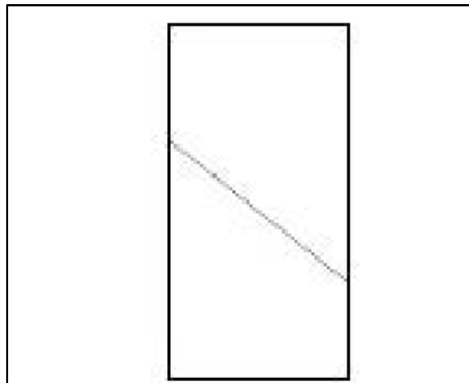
Fractura tipo VI. Fuente. NTP 339.034 / ASTM C-3
